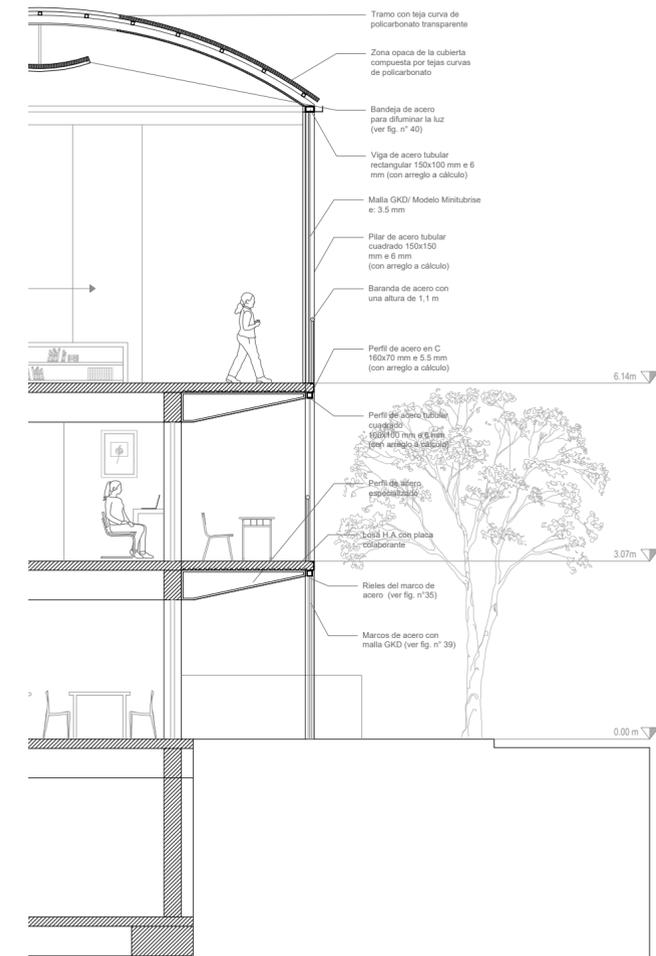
Escantillón de la fachada oriente. Fuente: Elaboración propia
